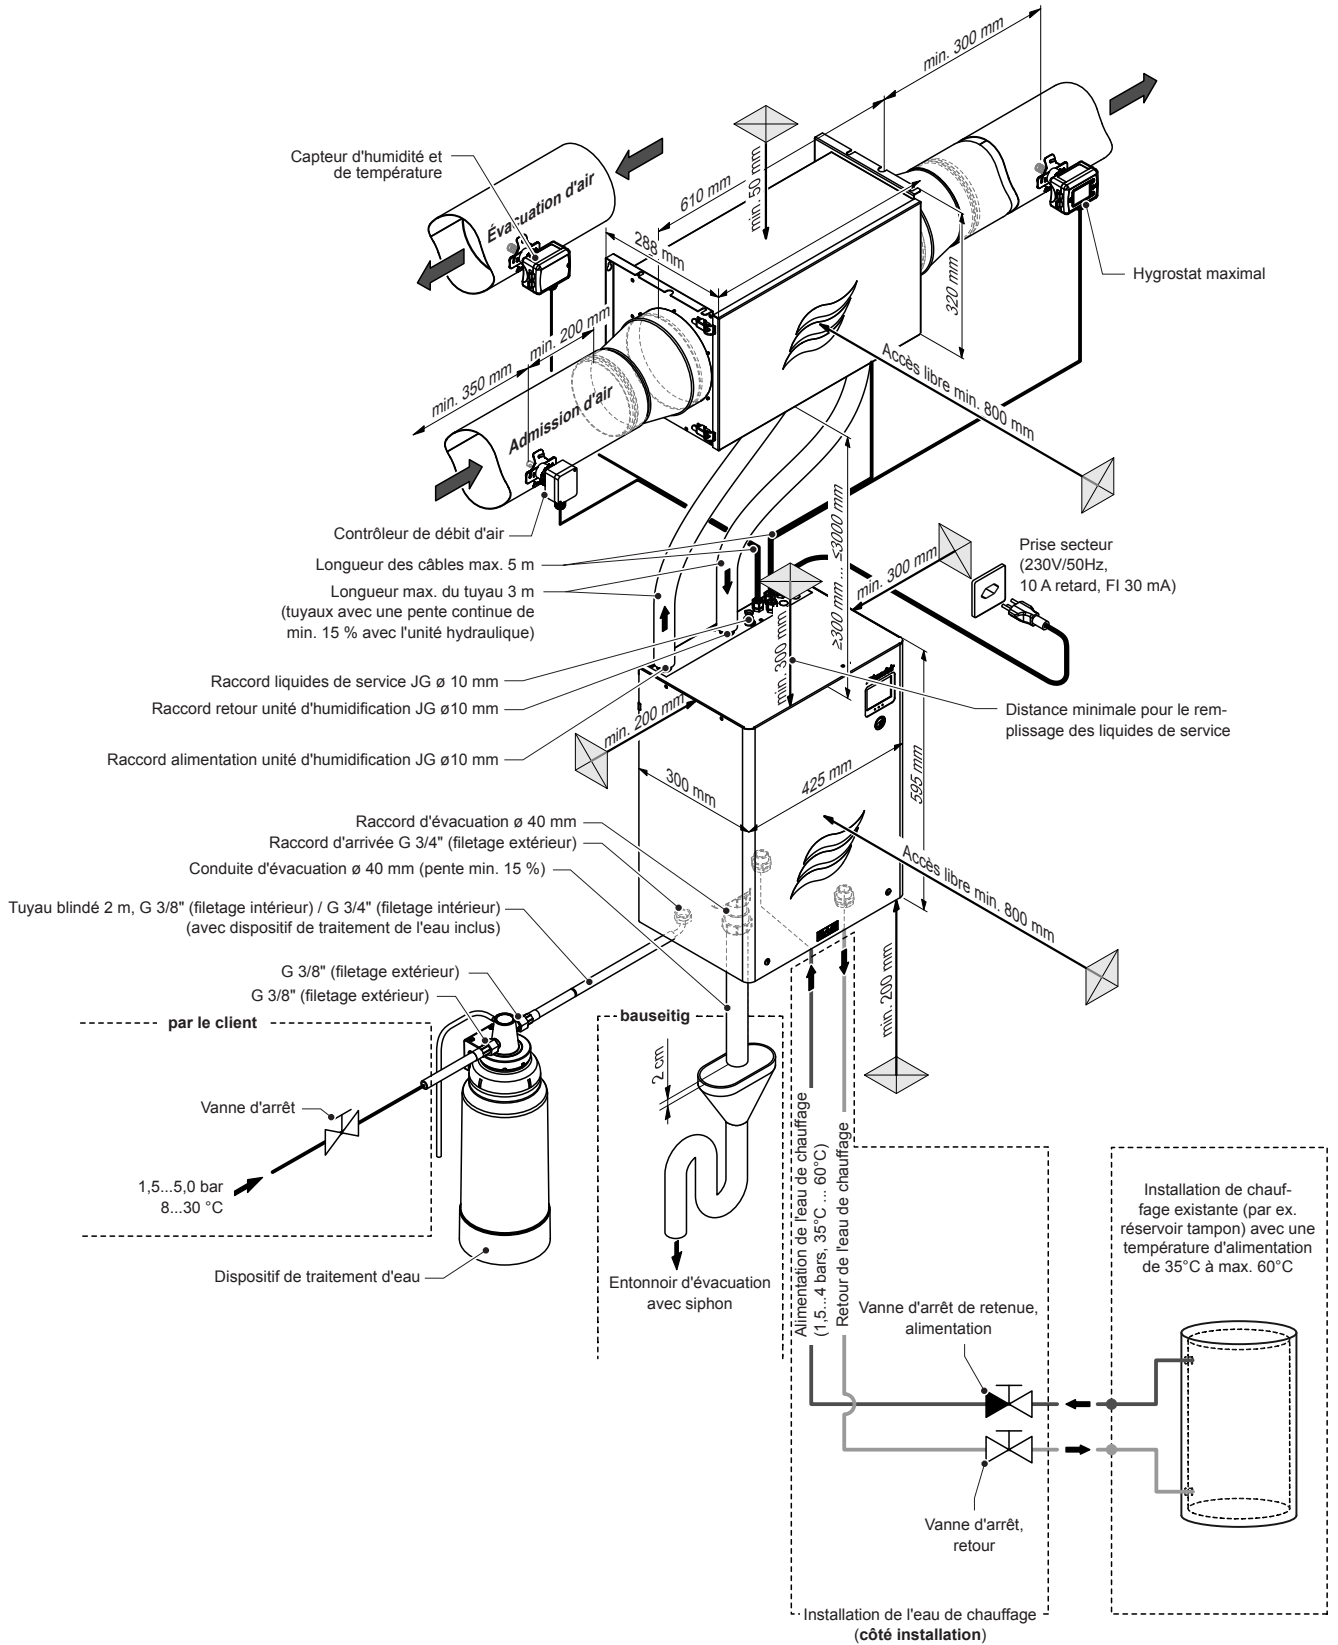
Aperçu de l'installation du Condair MD, variante MD-HW-H
